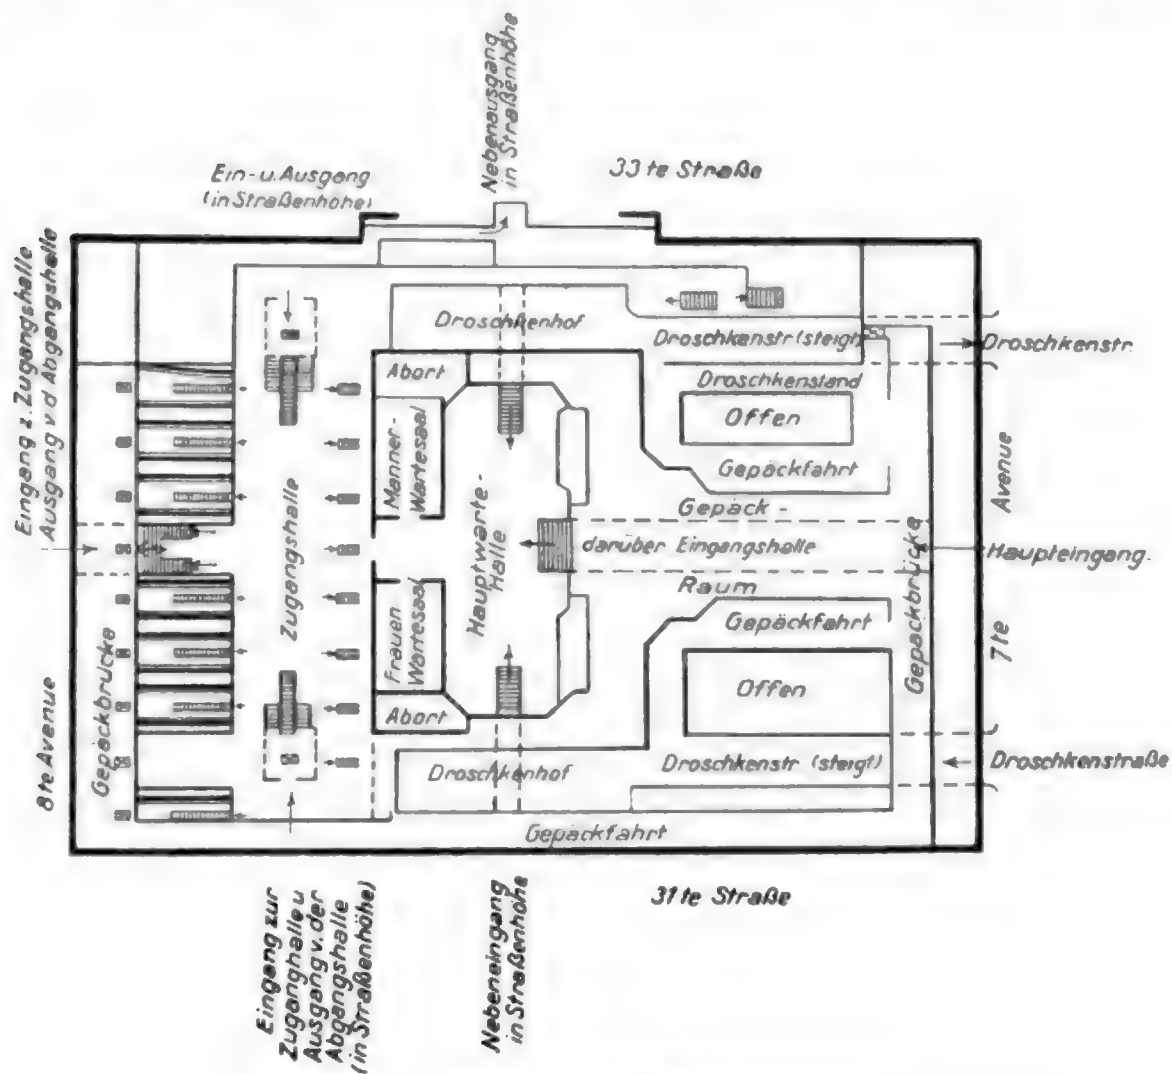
Pennsylvaniabahnhof in New York (Grundriß).
